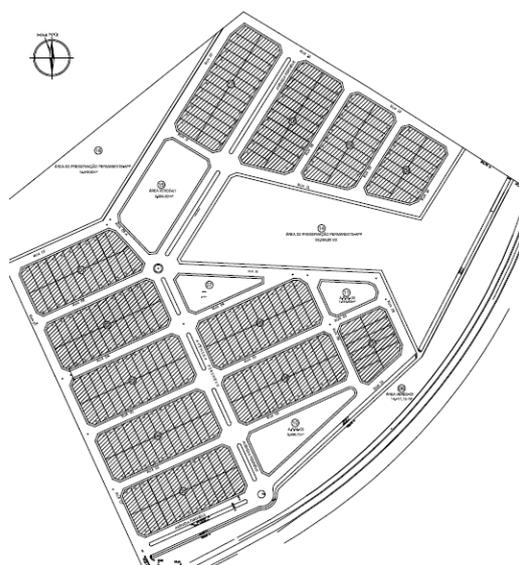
Projeto do Loteamento – Loteamento Luciano Peixoto
